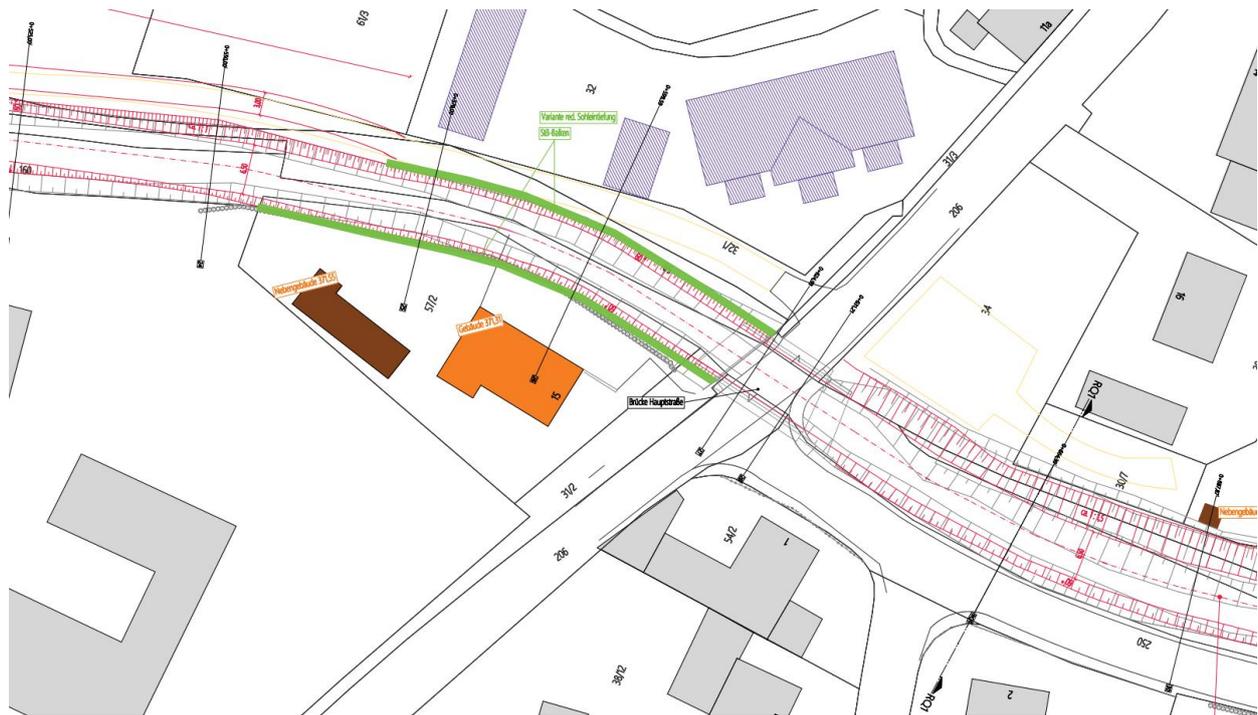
Lageplan Erhöhung der Böschungsoberkante Variante 2
